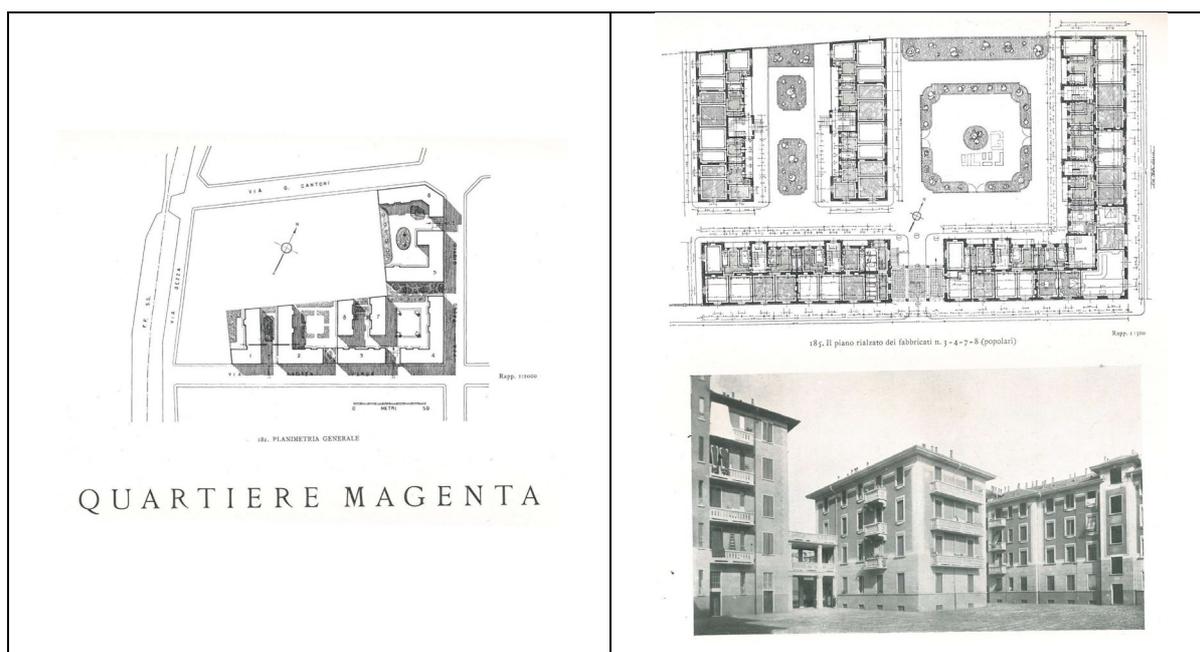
Quartiere Magenta. Planimetria. Pianta di un blocco e foto d'epoca.
